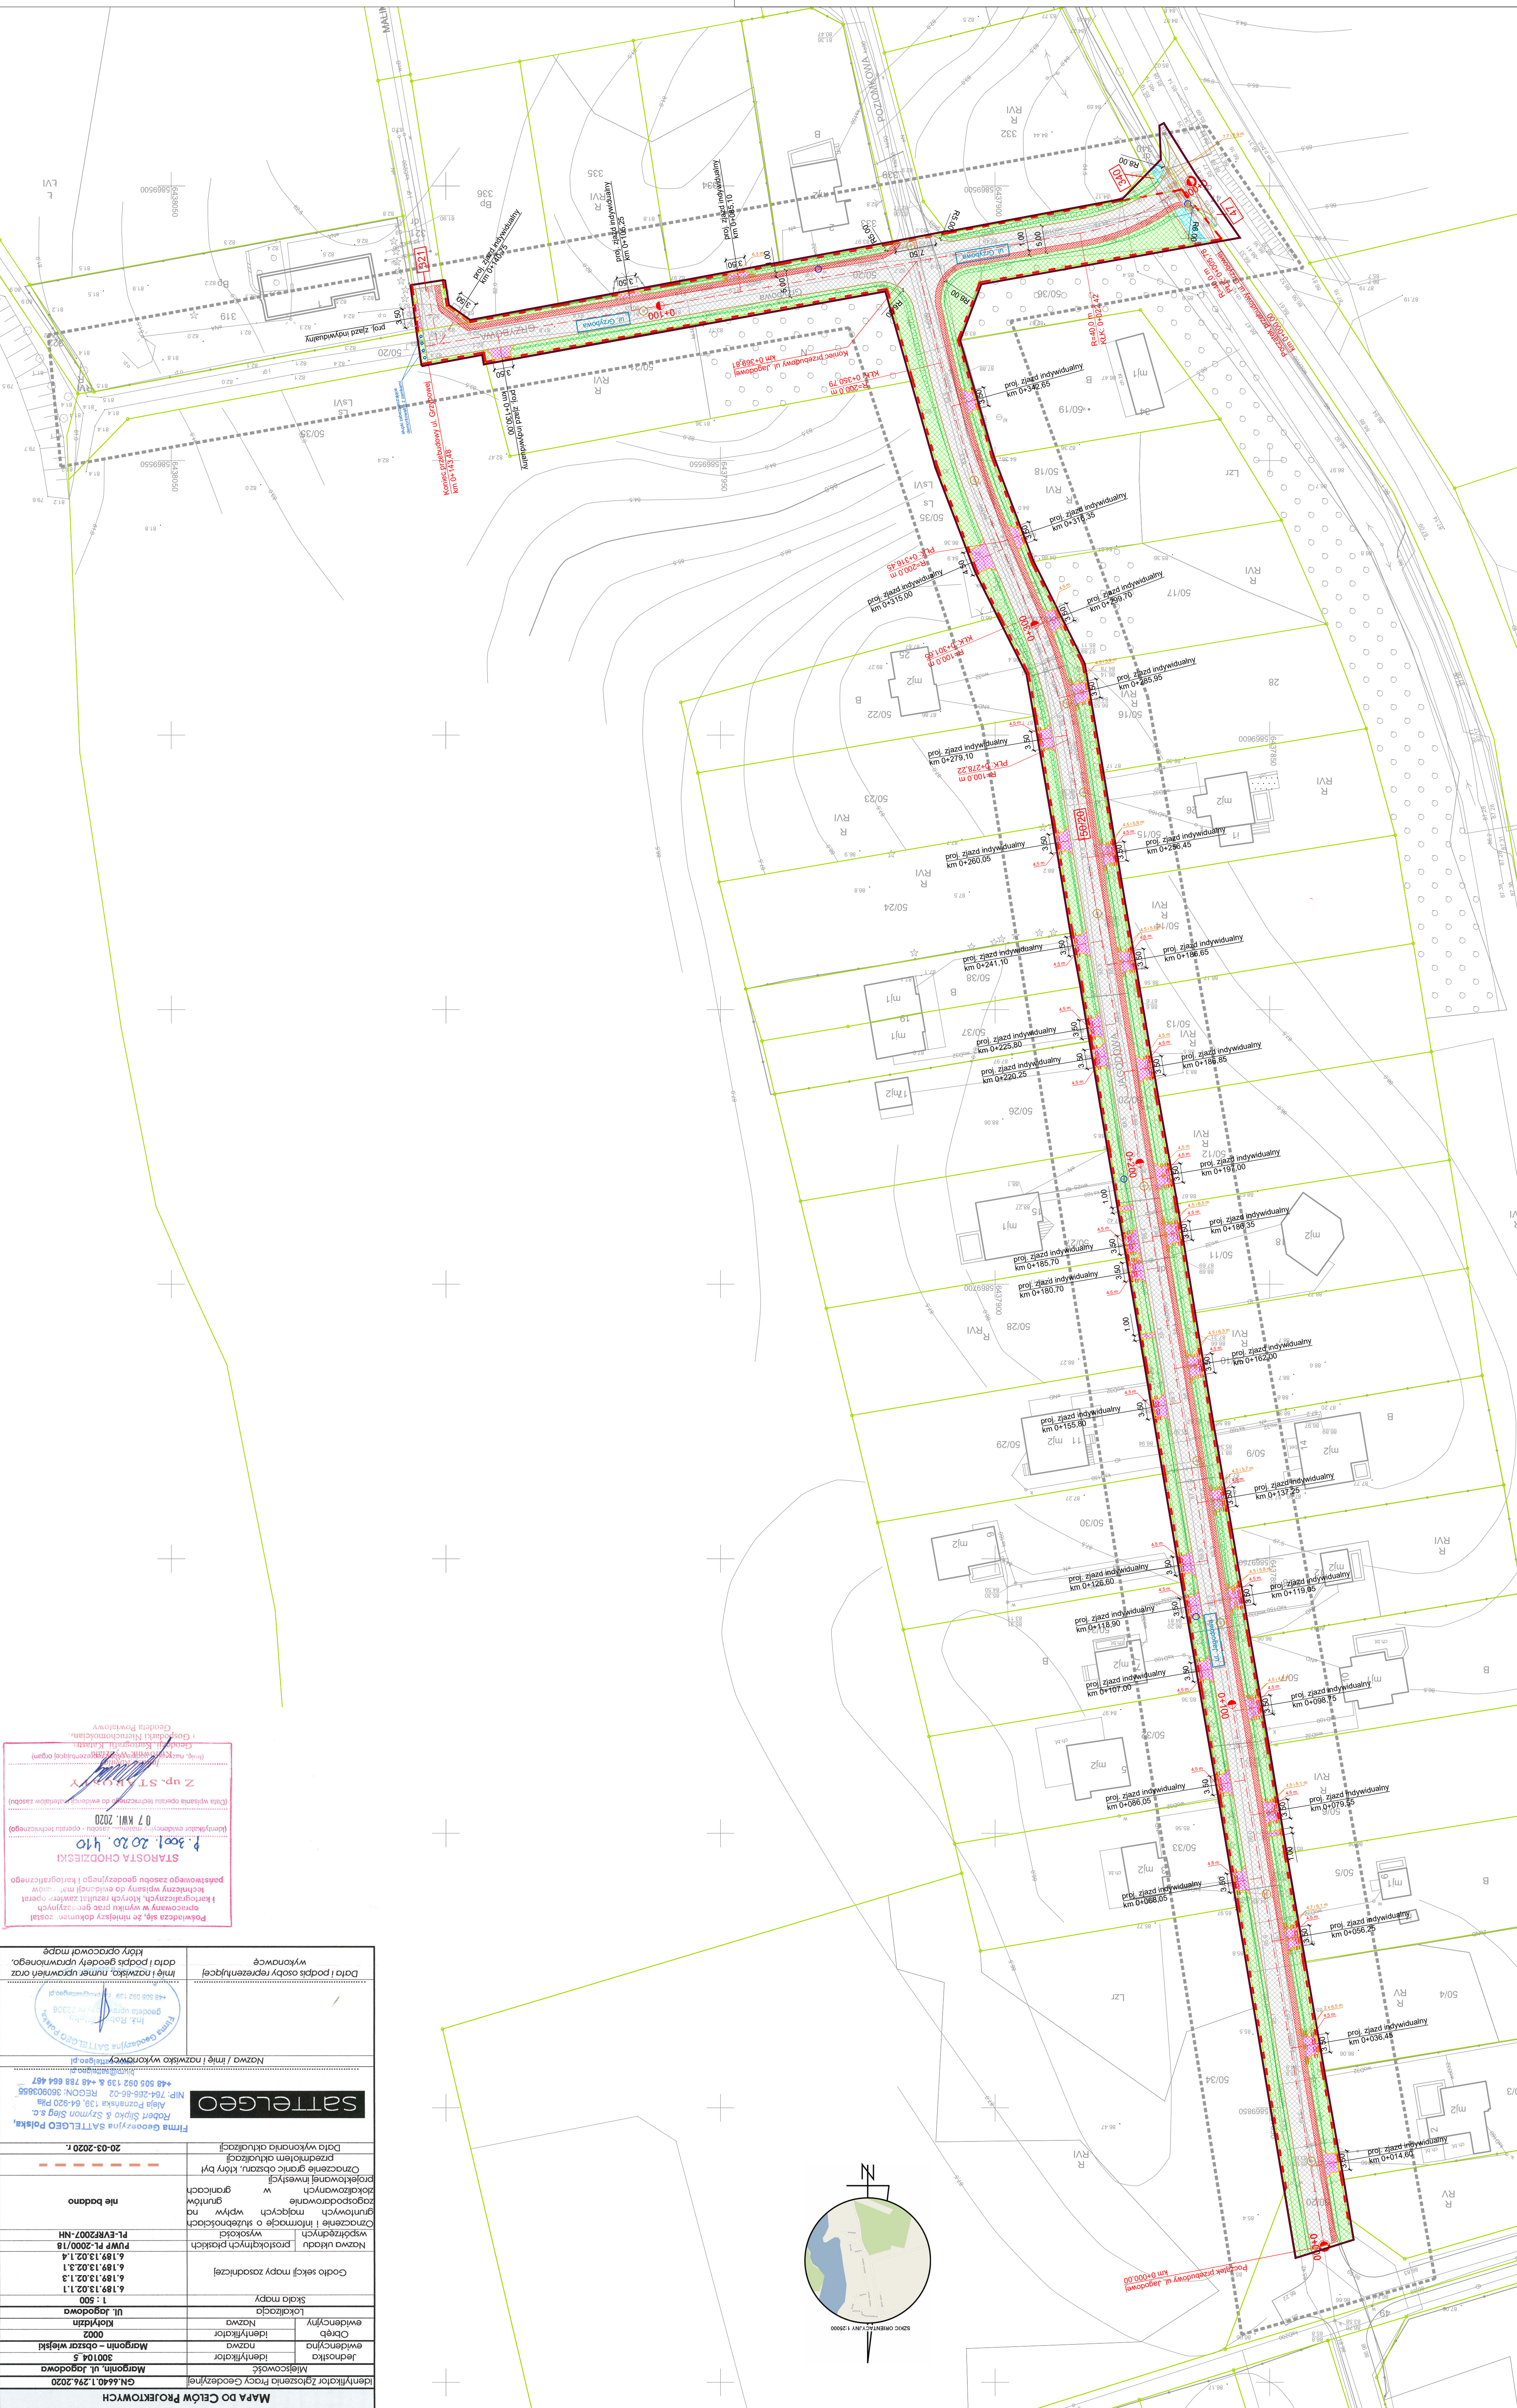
PZT	Plan orientacyjny	str. 19
